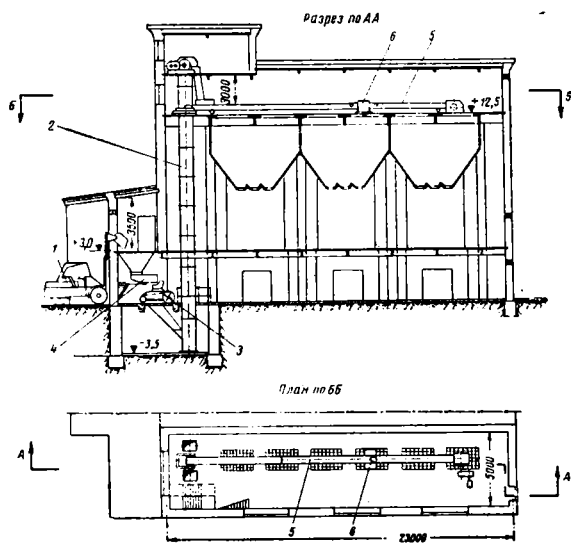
Скиповая топливоподача (схема Т-6): 1 — автопогрузчик; 2 — ковш подъёмника; 3 — дозатор; 4 — лебёдка подъёмника; 5 — лотковый питатель; 6 — двухвалковая зубчатая дробилка
